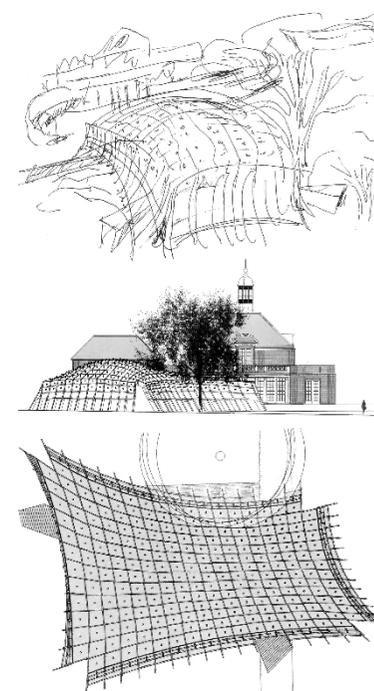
(1ª) Croquis del arquitecto. (2ª) Alzado relación pabellón-Galería. (3ª) Planta del pabellón.
